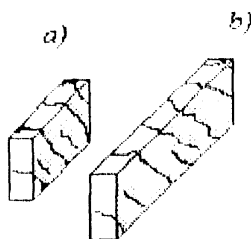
, Patrón de grietas en vigas diafragma, sujetas a fuerza de torsión.
